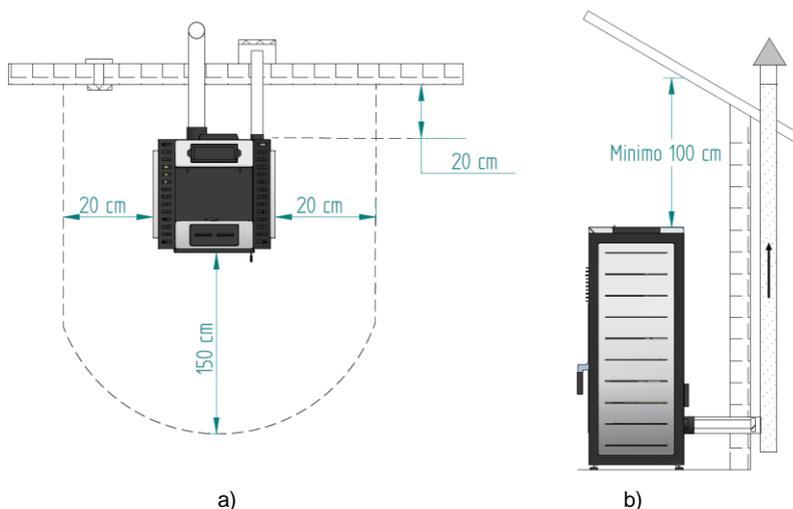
Distanze minime con tutte le superfici: a) vista dall'alto dell'installazione della stufa; b) vista laterale dell'installazione della stufa
